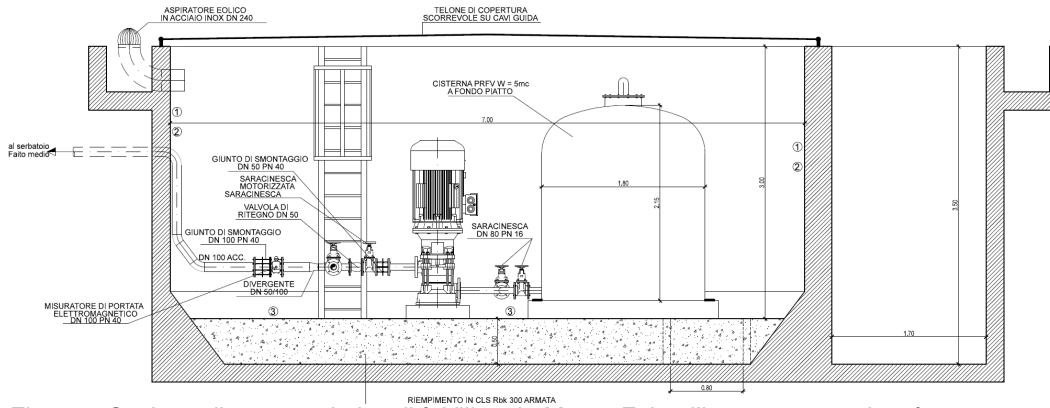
Sezione di progetto in località Villaggio Monte Faito: l'intervento previsto è contenuto all'interno delle preesistenti strutture, e sarà dunque completamente celato all'esterno
